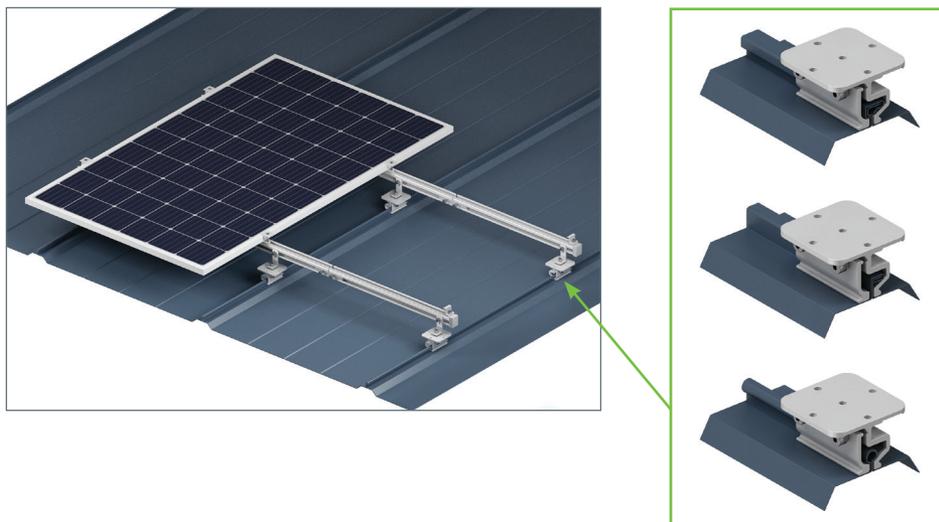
Крепежные элементы к металлочерепице или мягкой кровле
